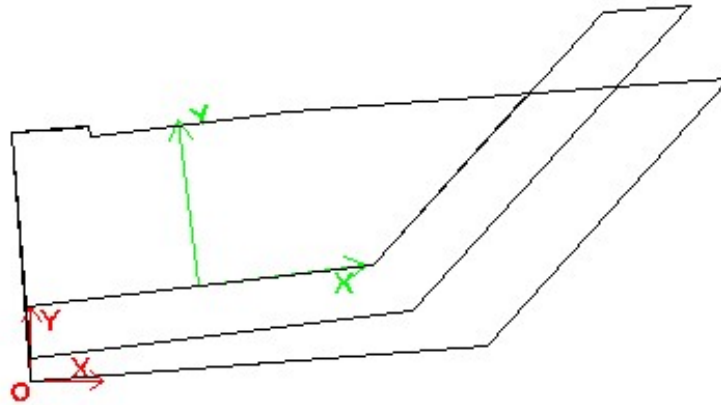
sistema di riferimento globale della fondazione e locale del muro d'ala
